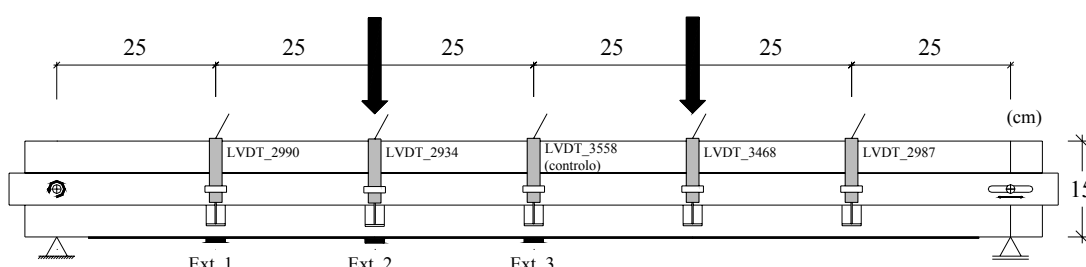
Disposição dos LVDTs e dos extensómetros (Ext.1, Ext.2 e Ext.3).
